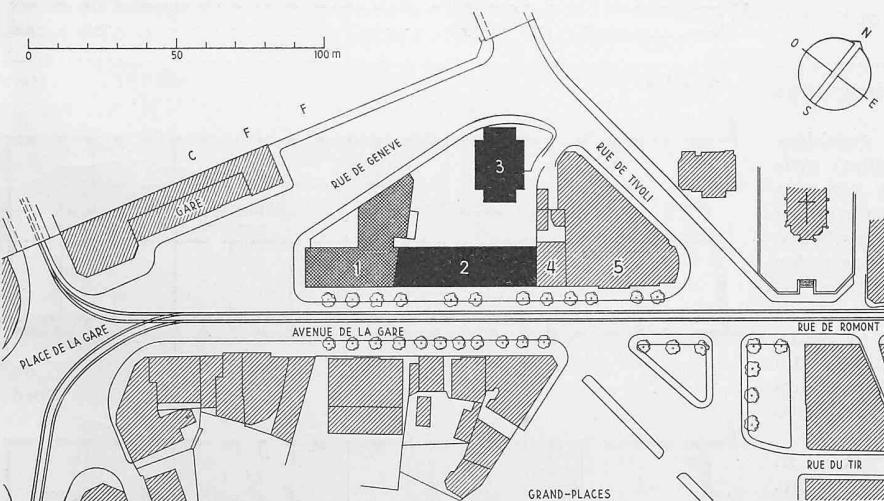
Lageplan 1:2500. — 1 Bestehender Bau der «Baloise Vie»; 2 Neubau an der Avenue de la Gare, 3 Neubau an der Rue de Tivoli, 4 bestehender Bau Späth, 5 bestehender Bau der Schweiz. Volksbank
